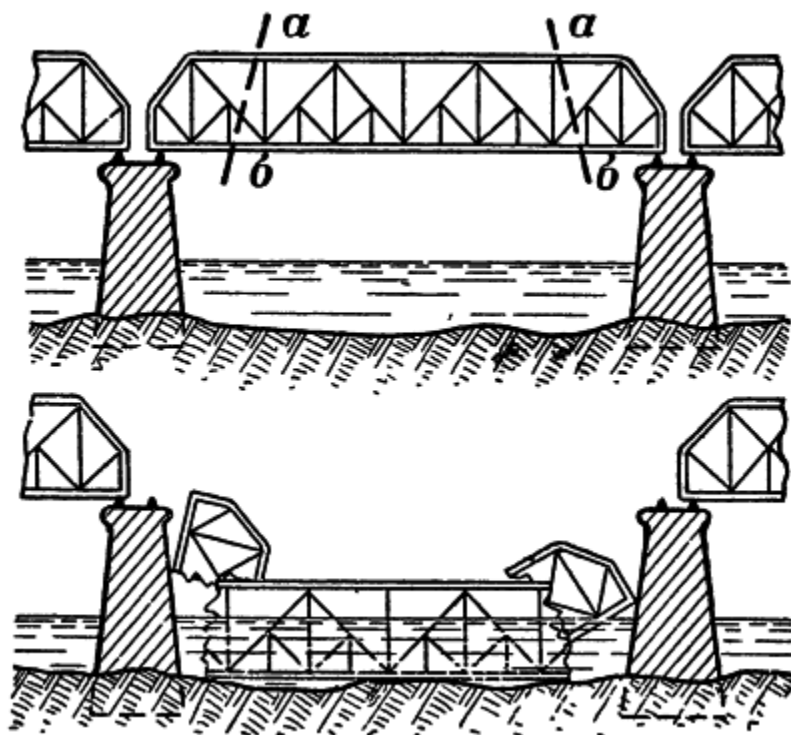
Схема подрывания мостовых ферм у обеих опор: аб — линия перебивания ферм
